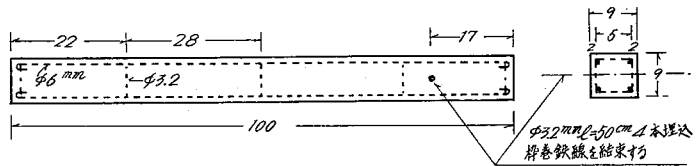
1 鉄筋コンクリート部材詳細図 S = 1/10
